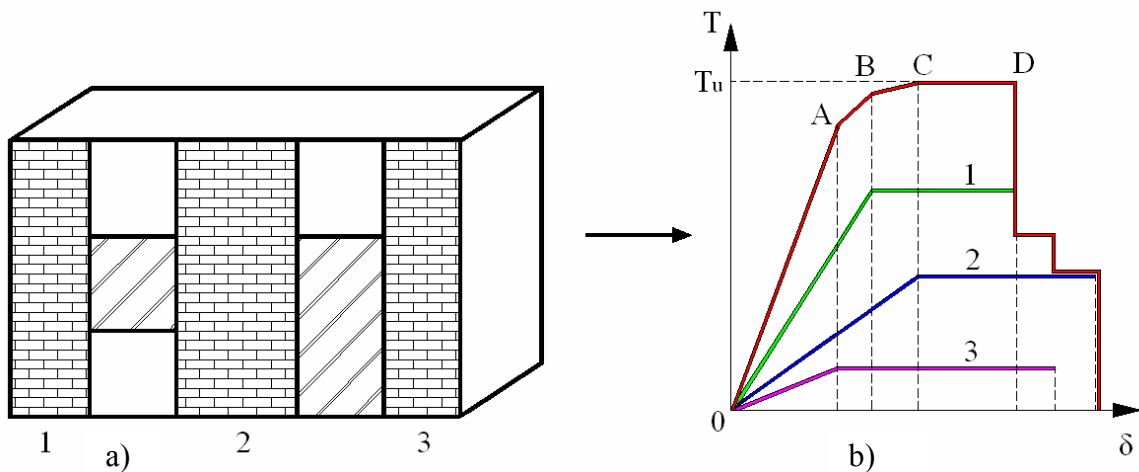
a) Suddivisione della parete in maschi murari; b) Diagramma Forza-Spostamento globale
